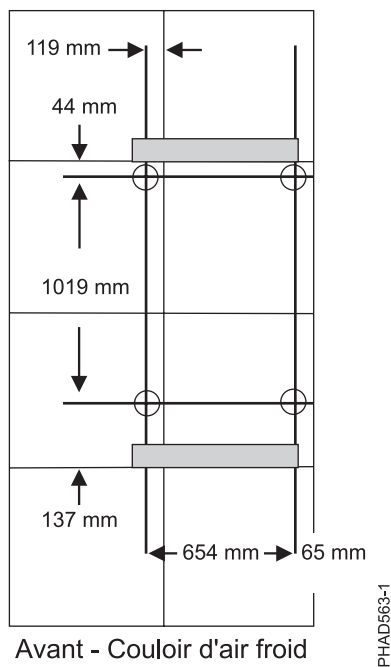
Modèle de trous d'ancrage pour armoire. Figure de faux plancher avec panneaux de plancher de 600 mm
